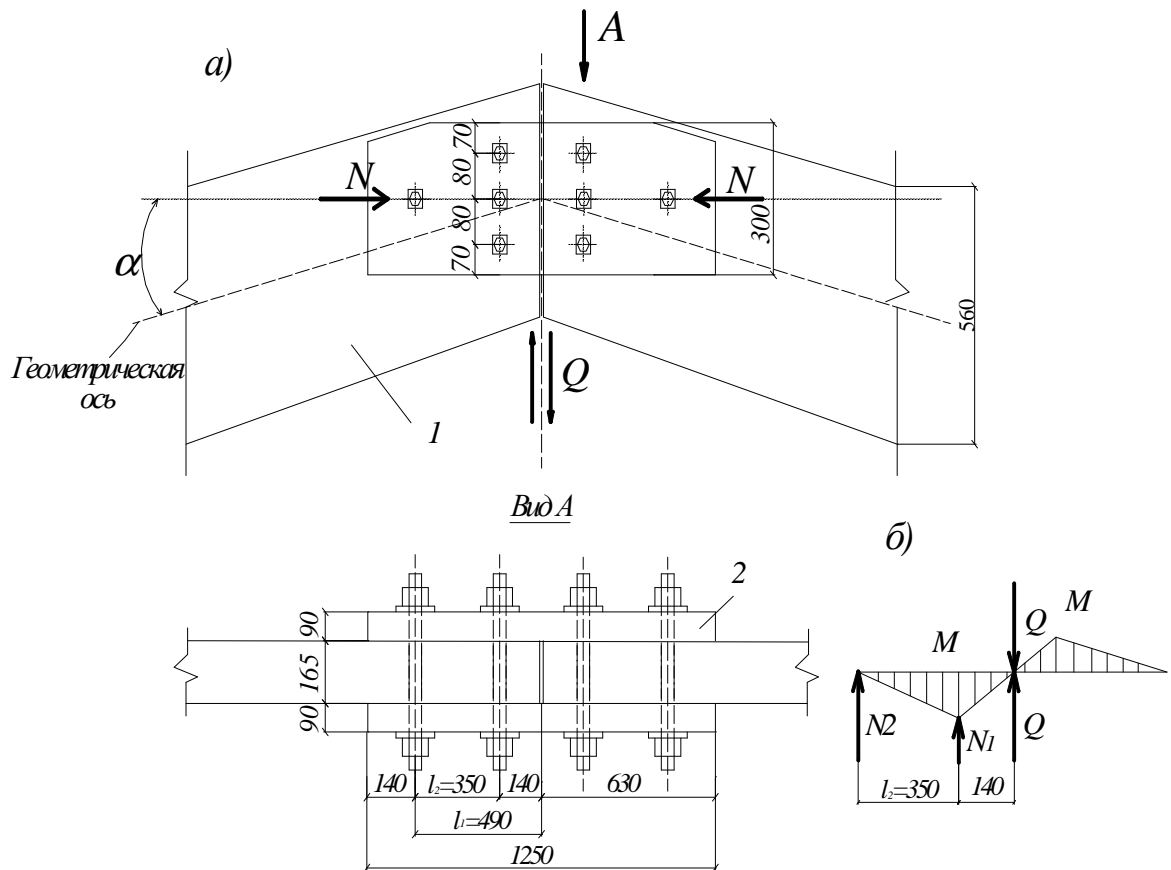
Коньковый узел с деревянными накладками (а) и расчетная схема накладки (б): 1 - полурама; 2 - накладка
